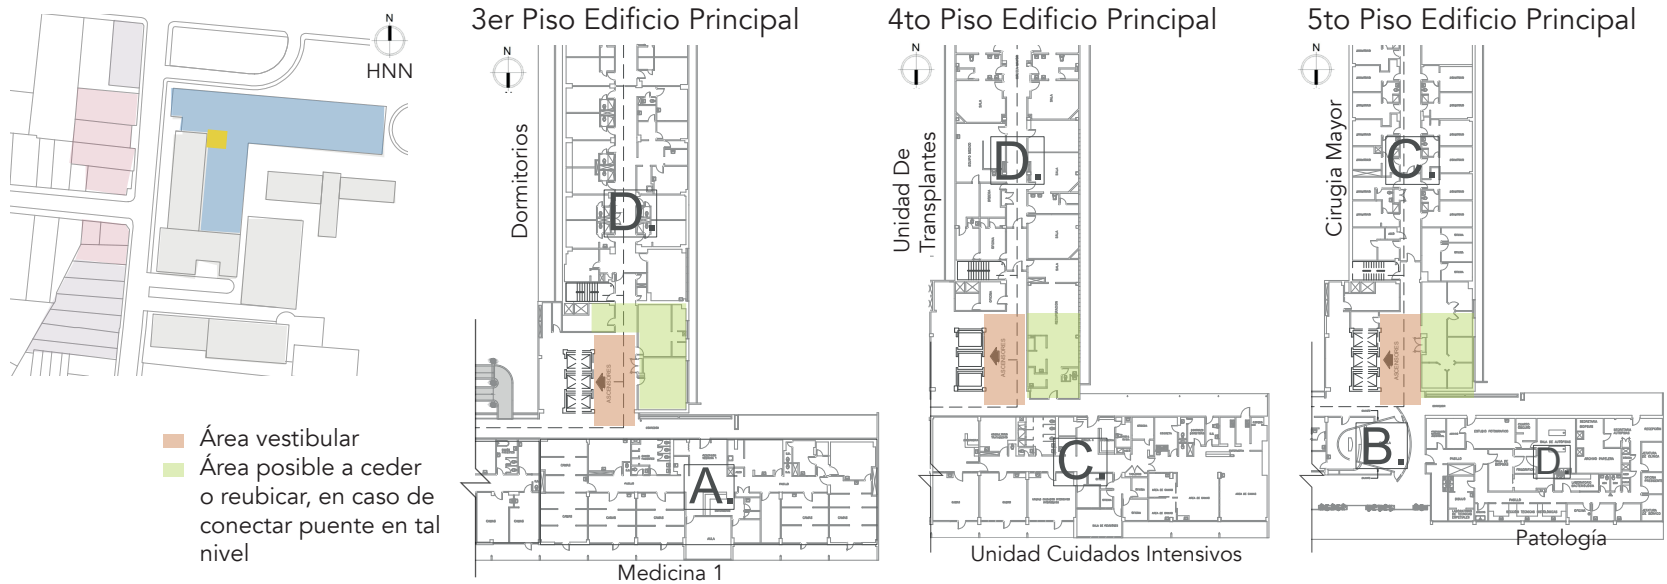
Ubicación de Vestíbulo HNN (2018) Fuente: Zheng Yang, K. Planimetría provista por el CeAPH.
